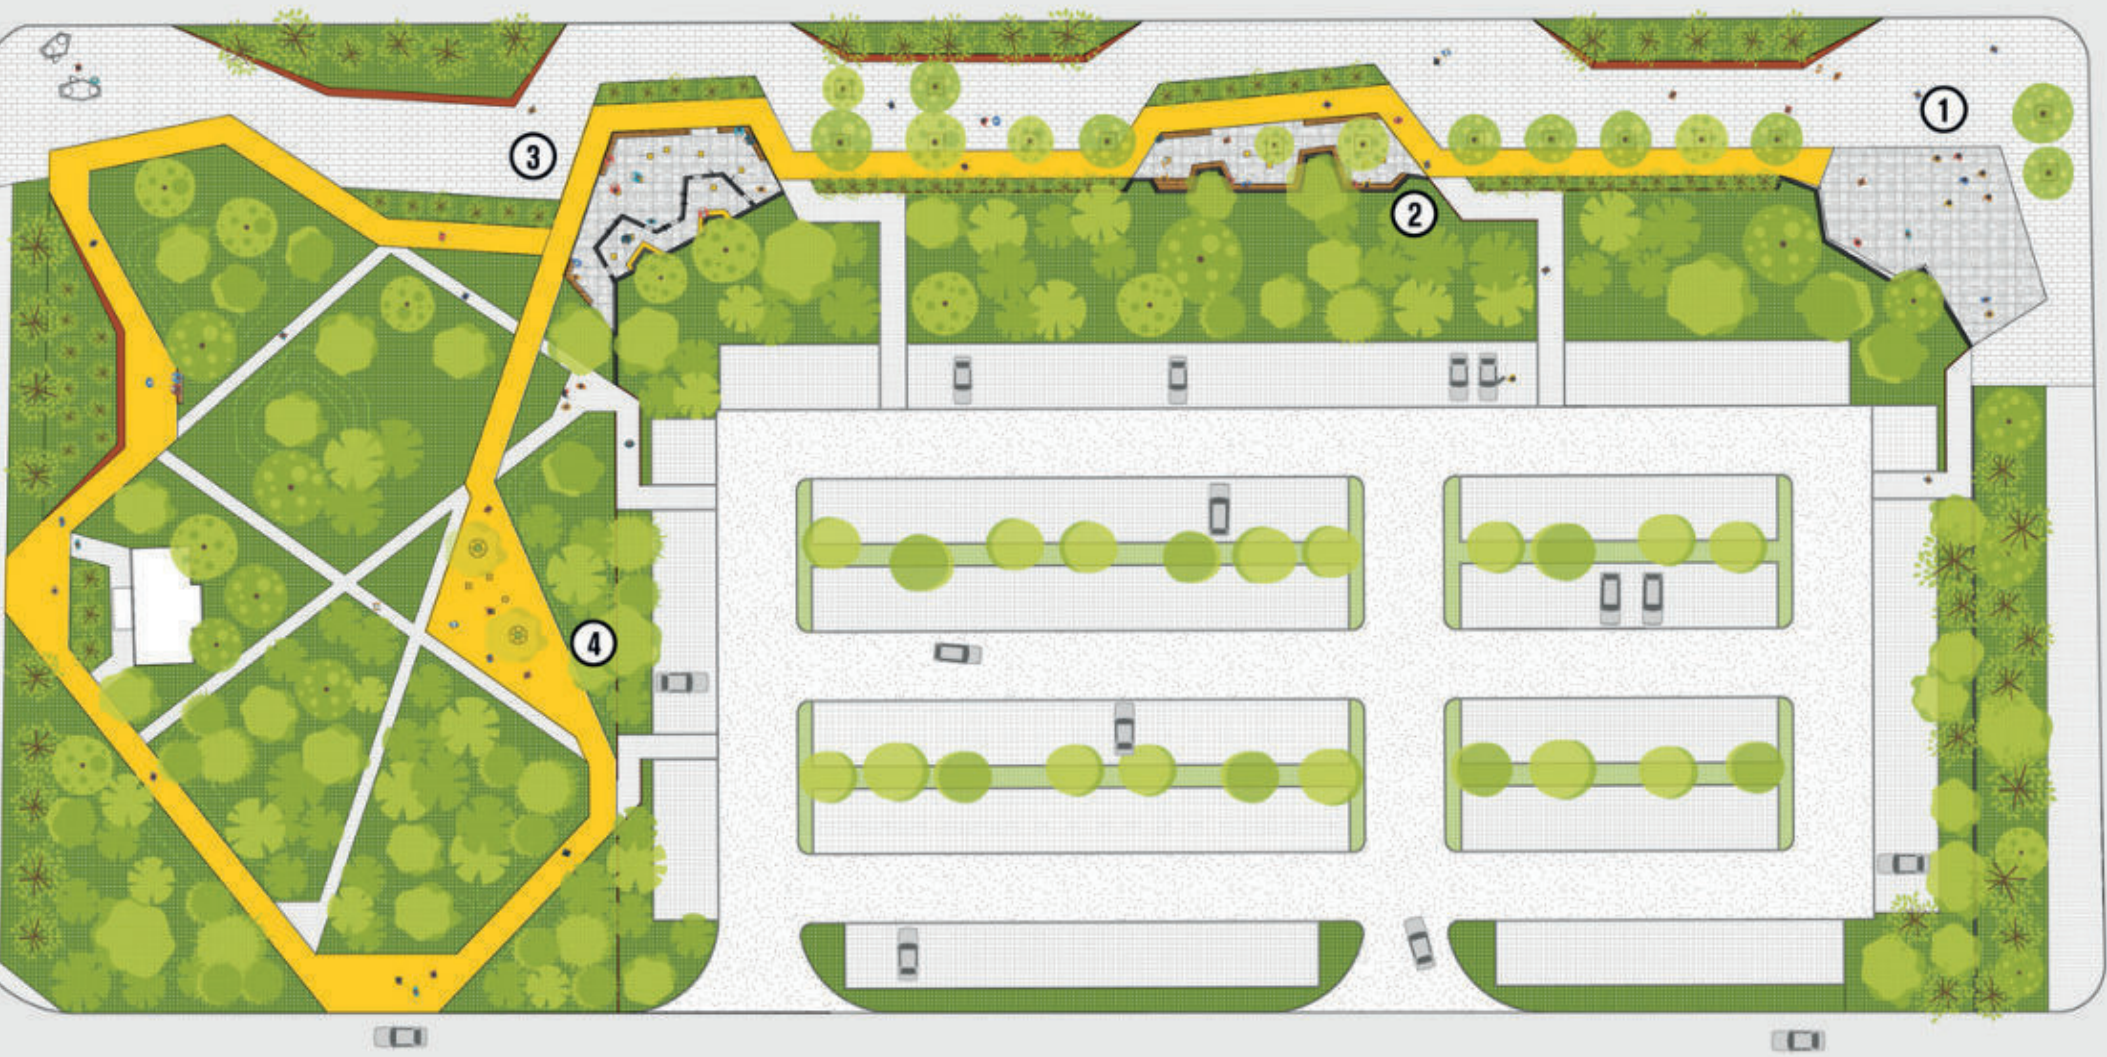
Planta arquitectónica del proyecto Microparque comunitario Songzhuang, Elaboración: Crossboulders, Beijing, China 2021.
